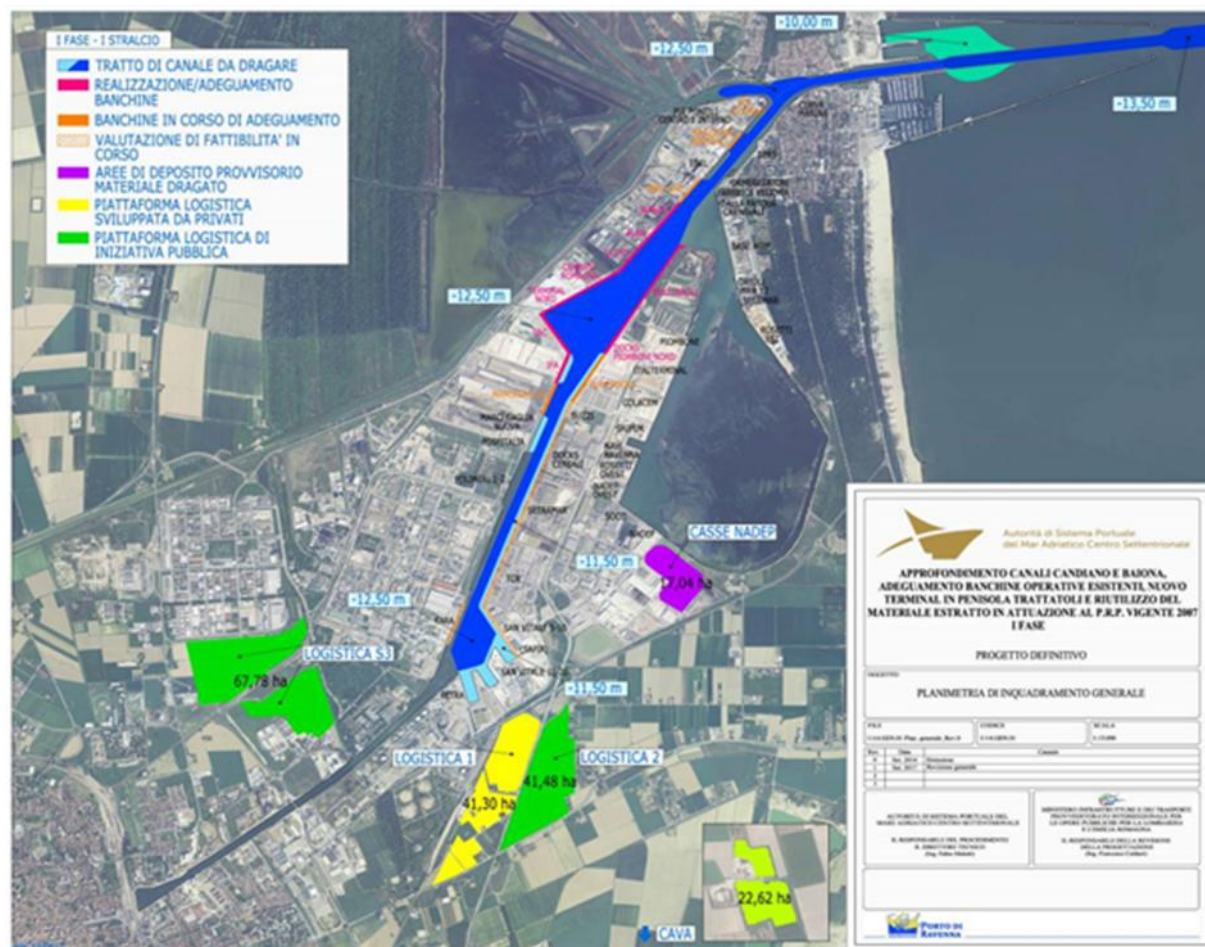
Planimetria di inquadramento generale Progetto HUB – progetto definitivo
